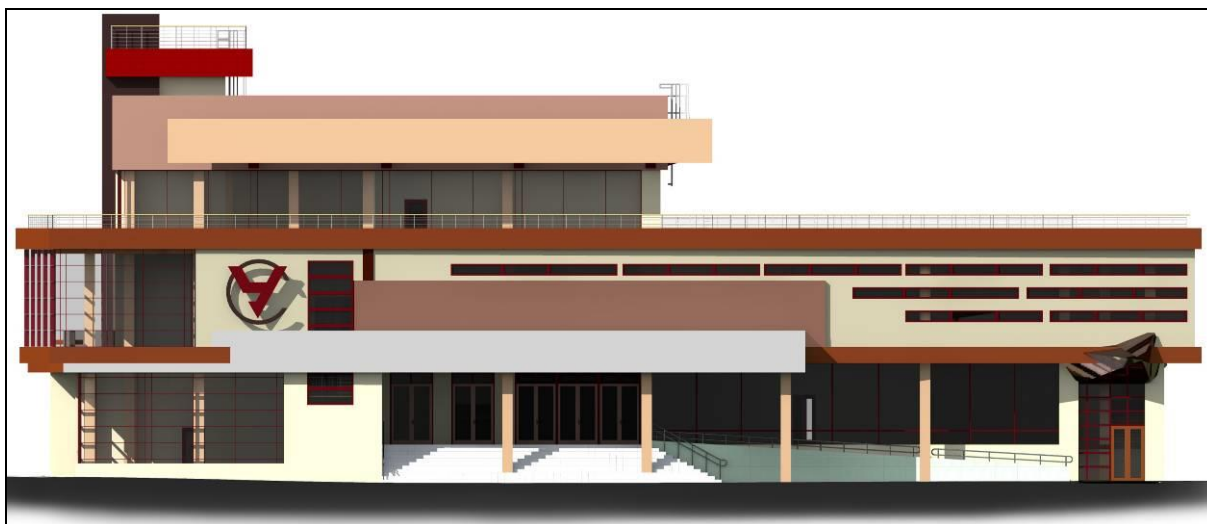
Главный фасад Мещерского университета (проект реконструкции)
